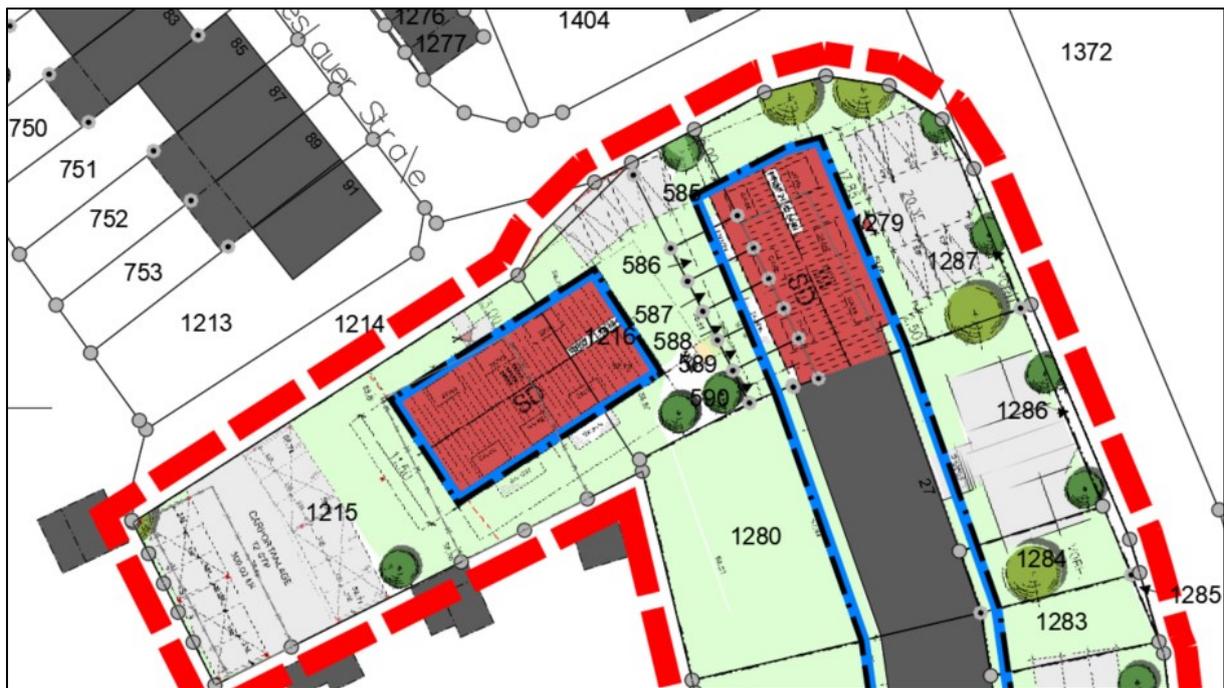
Überblendung der Baugrenzen mit den geplanten Gebäuden
